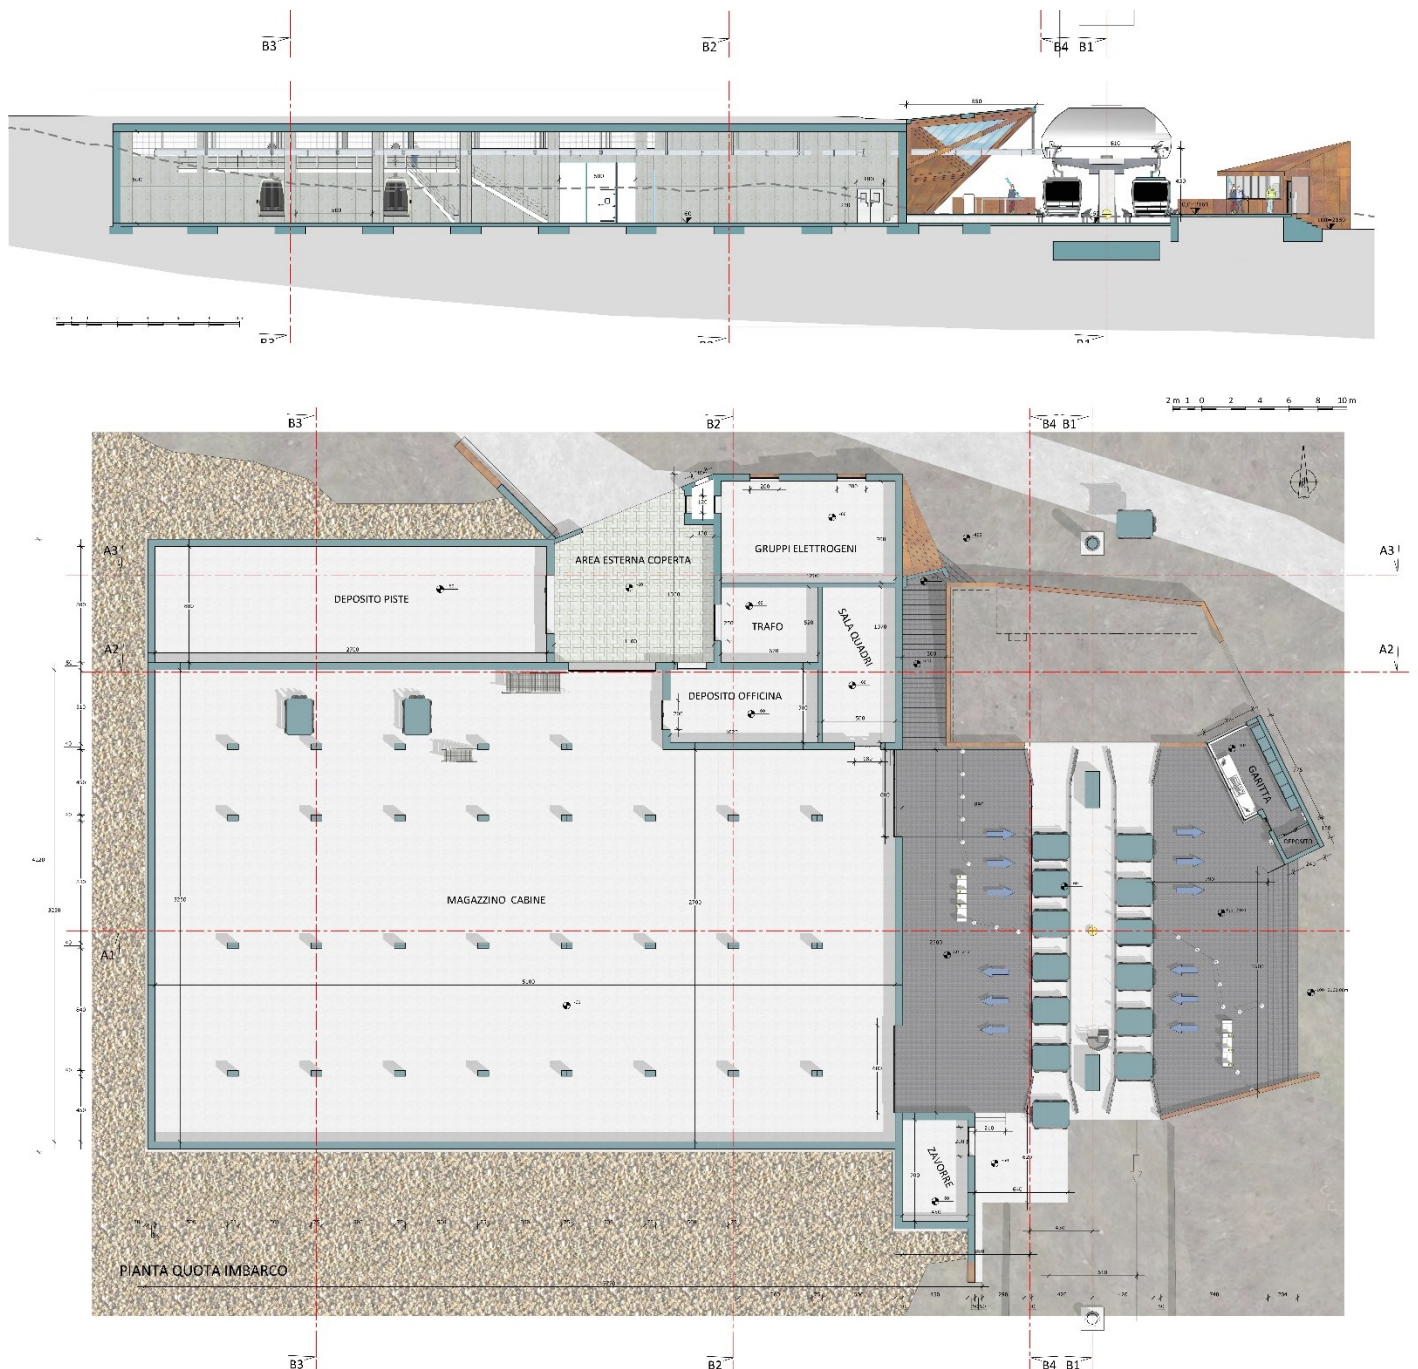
PIANTE E SEZIONE NUOVA STAZIONE INTERMEDIA COUIS CON MAGAZZINO CABINE
